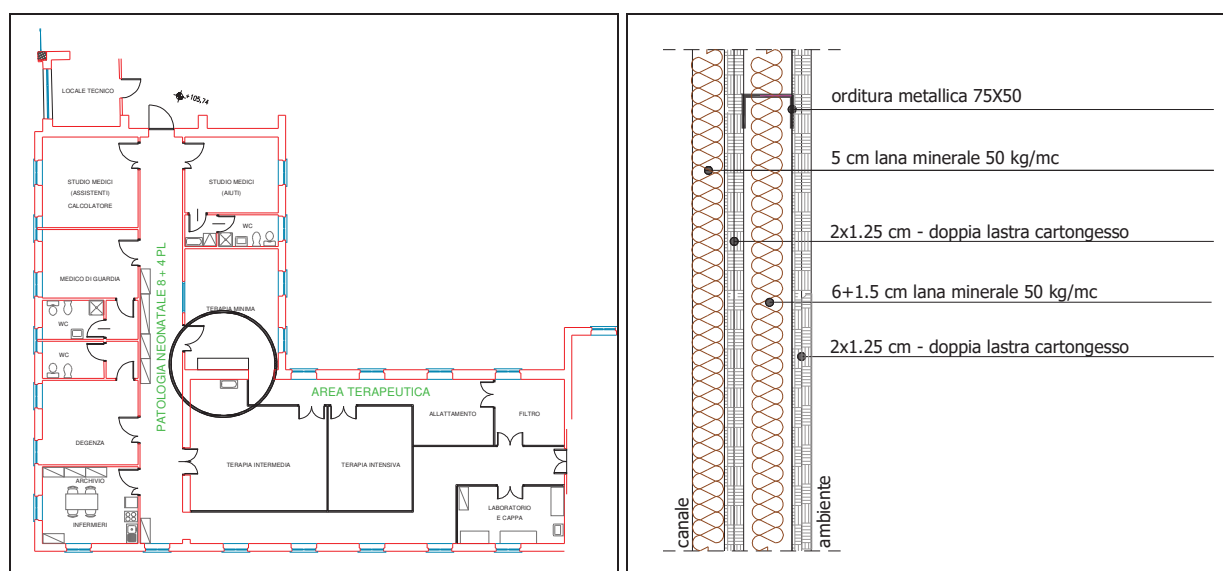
Stratigrafia della struttura a protezione dei canali nel passaggio interpiano
